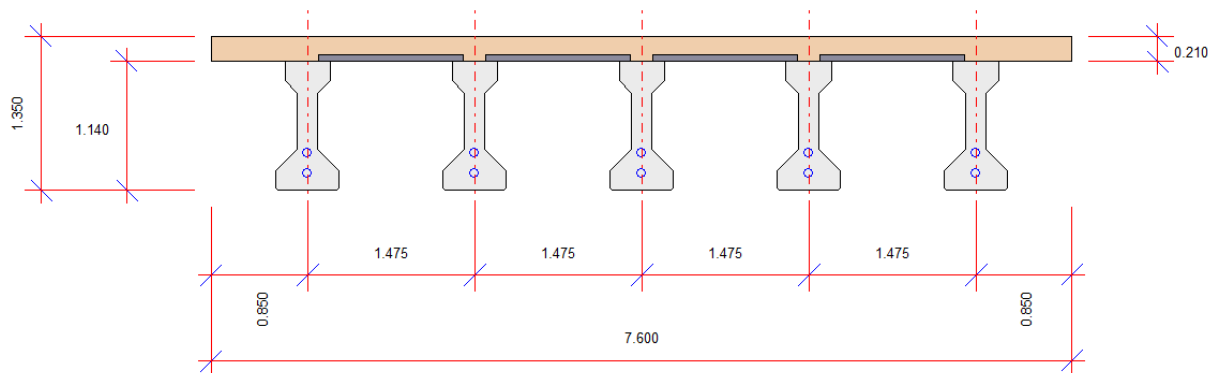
Sección tipo tablero 7.60m. Fuente: IDOM-DEHC.
